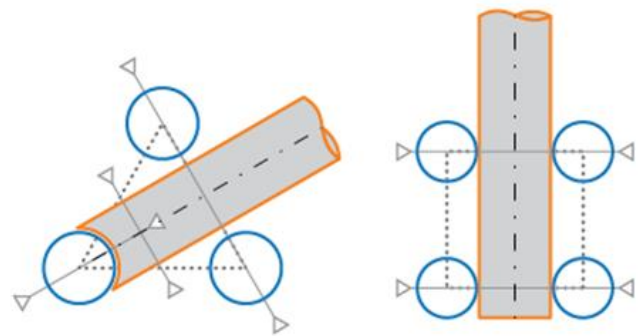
Vista en planta de la disposición triangular y cuadrada de pilares (azul) y vigas (naranja)
